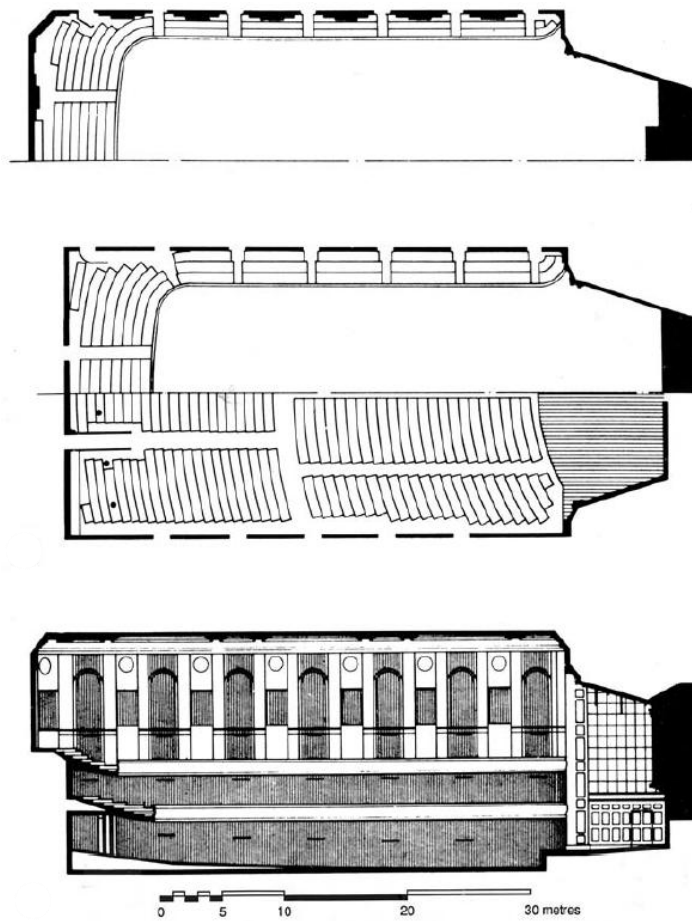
Planta e secção do Symphony Hall, Boston. [23]
